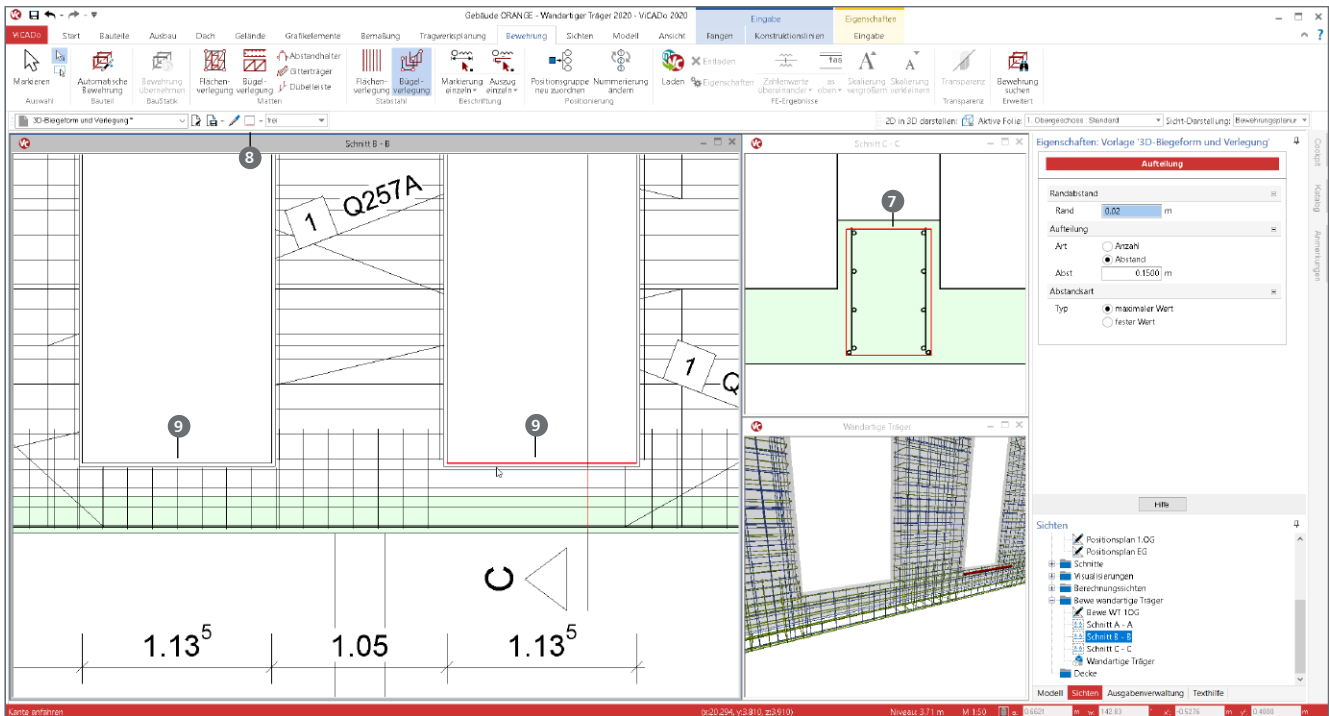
Manuelle Bewehrung unterhalb der Aussparungen
